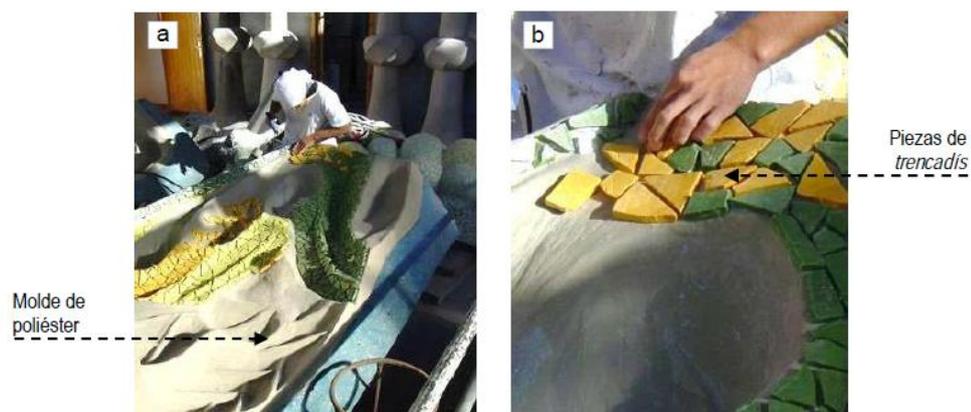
Colocación de piezas de vidrio en moldes para elemento prefabricado
